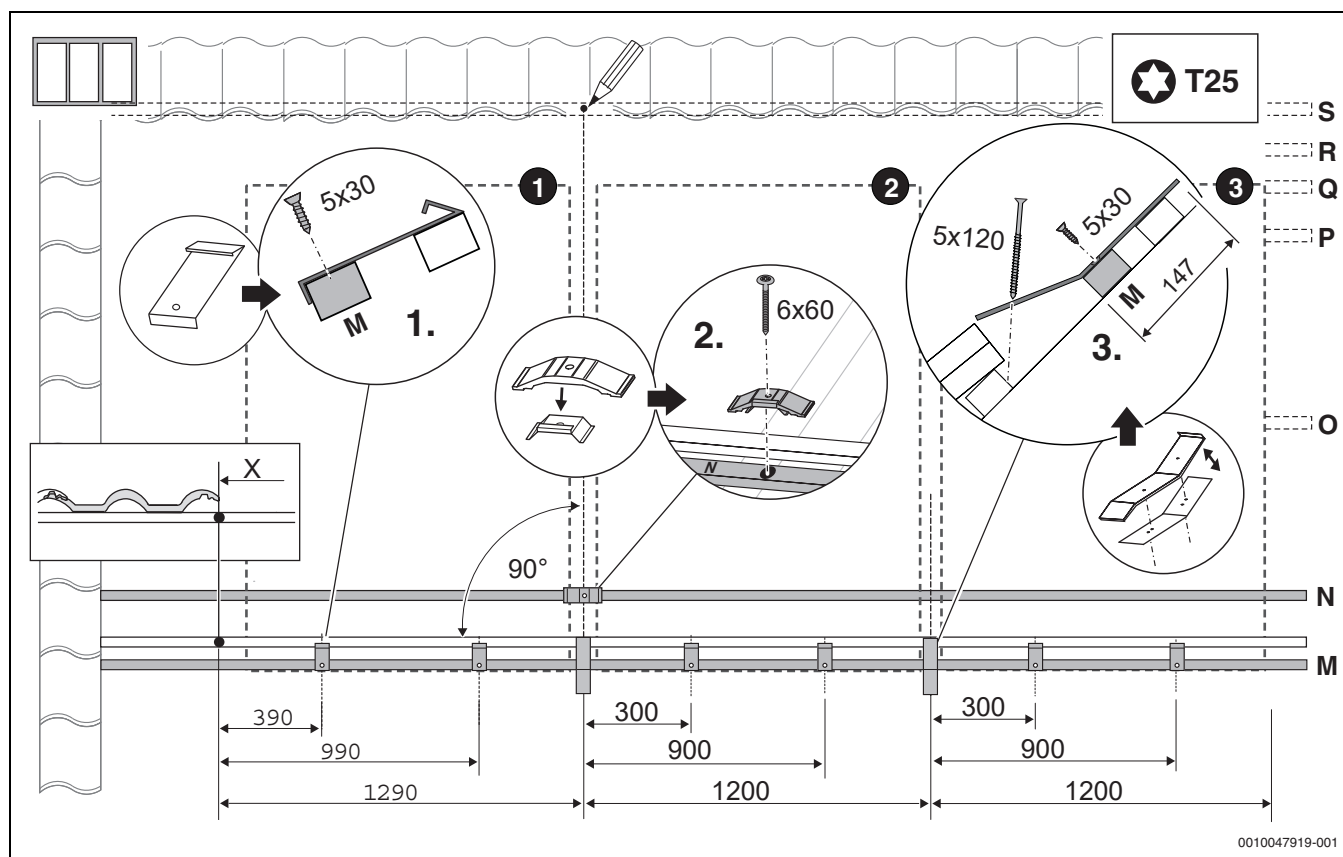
Kollektortyp senkrecht (3 Kollektoren), Maße in mm
